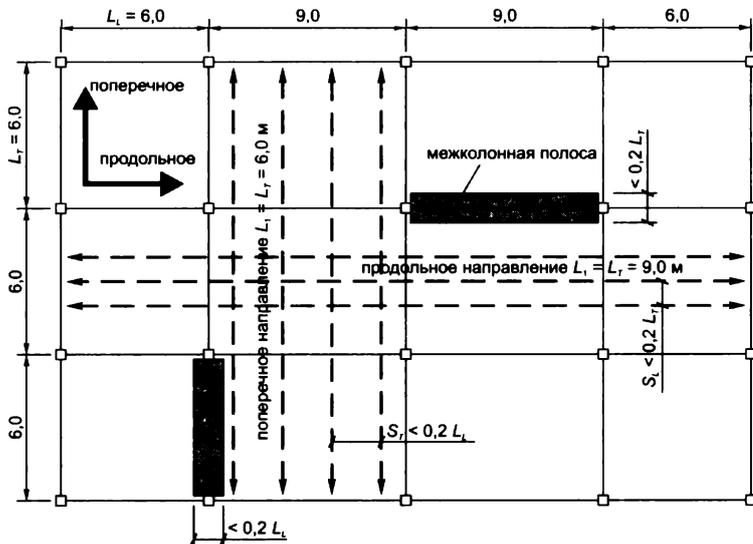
К определению величины расчетных пролетов L_i при расчете связевых усилий для рамно-каркасных зданий и зданий с несущими стенами и плитами, работающими в двух направлениях [14, 22]
